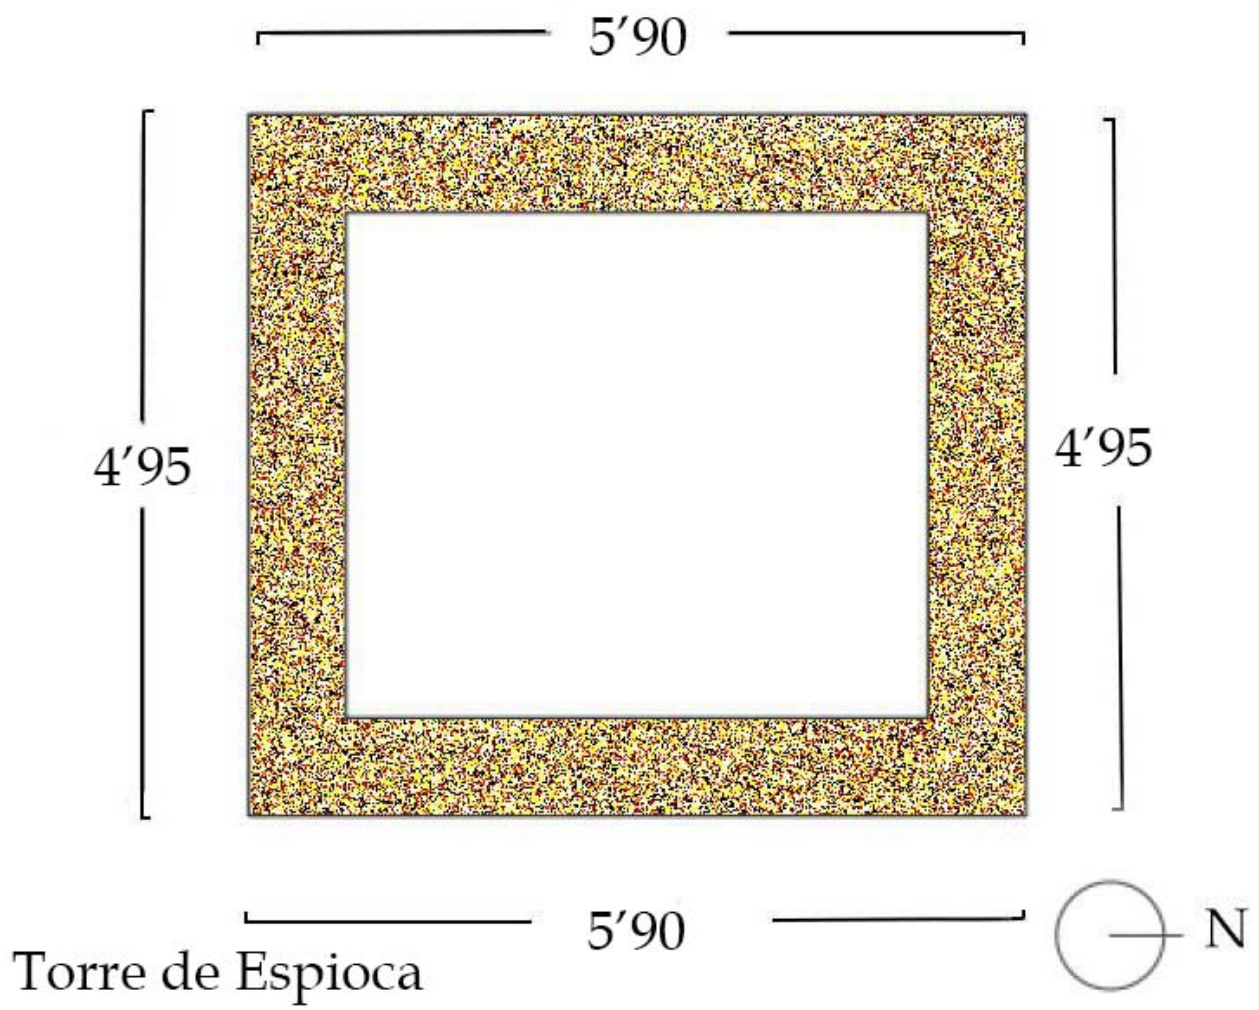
Planta de la Torre Espioca. Elaboración propia.
